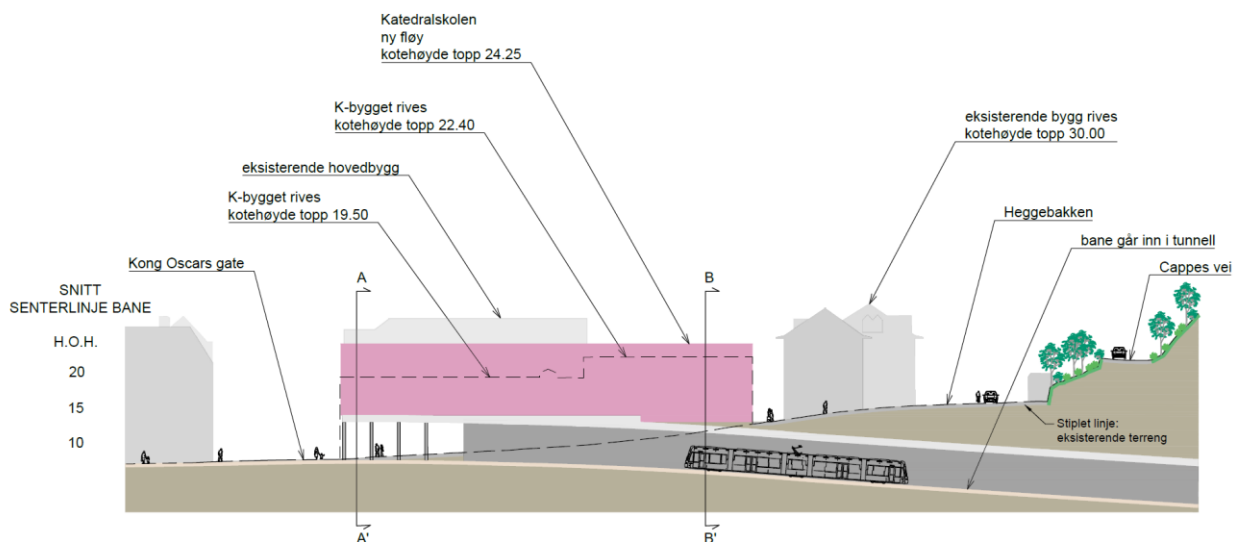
Tunnelalternativ 2C1, vurdert som det beste tunnelalternativet.
